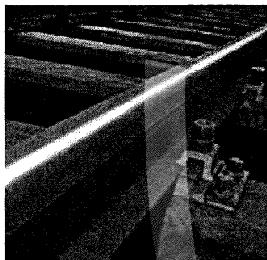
Жесткое раздельное рельсовое скрепление для деревянных шпал
